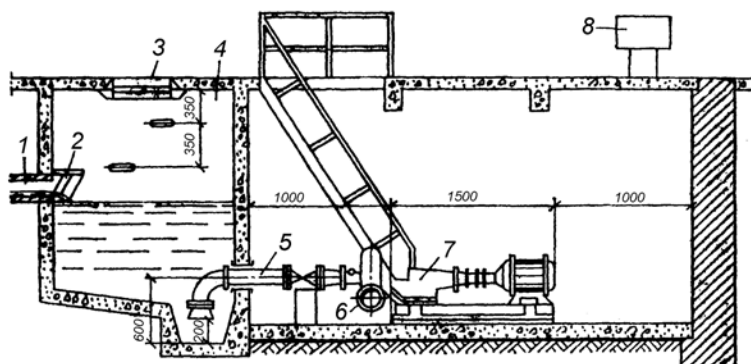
Насосная установка для перекачки сточных вод с приемным резервуаром: 1 – подающая труба; 2 – решетка; 3 – крышка; 4 – приемный резервуар; 5 – всасывающая труба; 6 – напорный трубопровод; 7 – насос; 8 – вентиляция.
